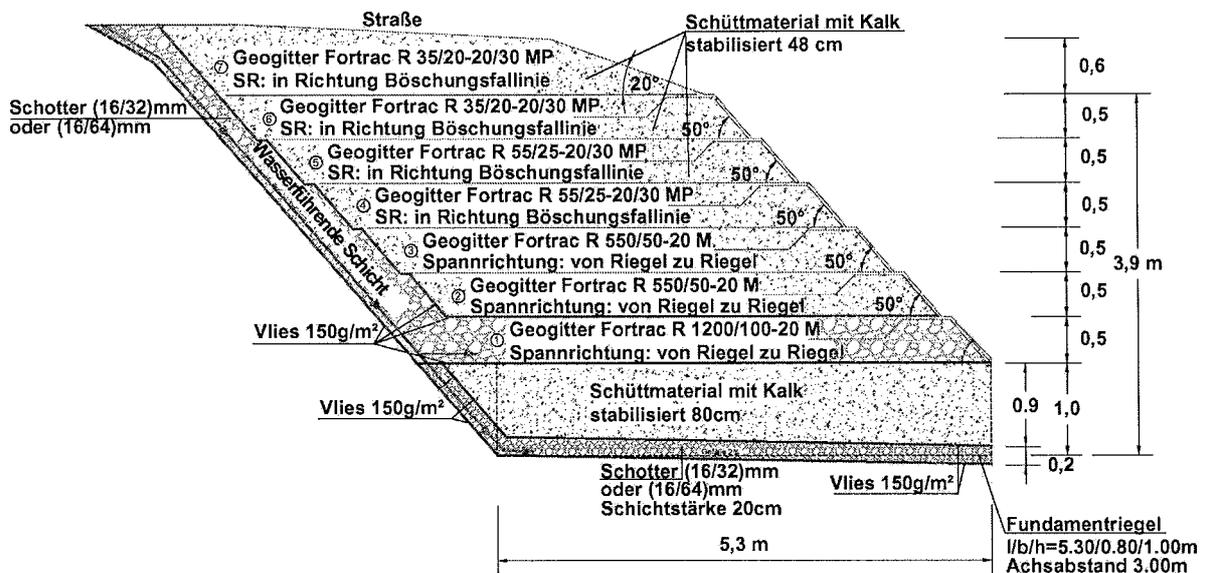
Stützkonstruktion bei Oberstdorf: Geogitterbewehrung. Spannrichtung der untersten Lagen beachten!
